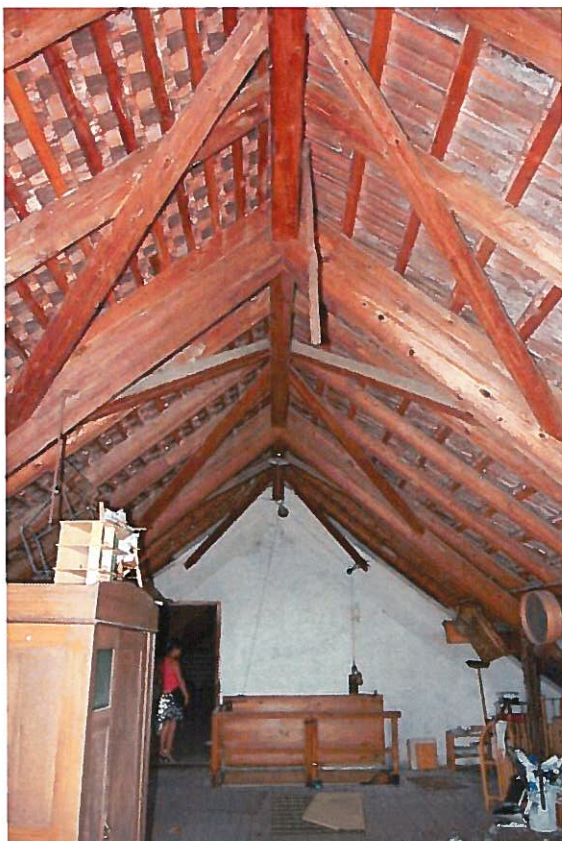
2. Dachgeschoss, Wohnhaus. Blick Richtung Westen.
